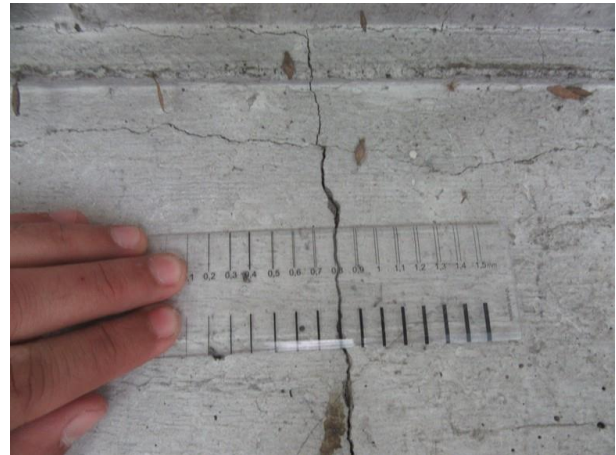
Transversina – Abertura de fissura igual a 0,8 mm.
